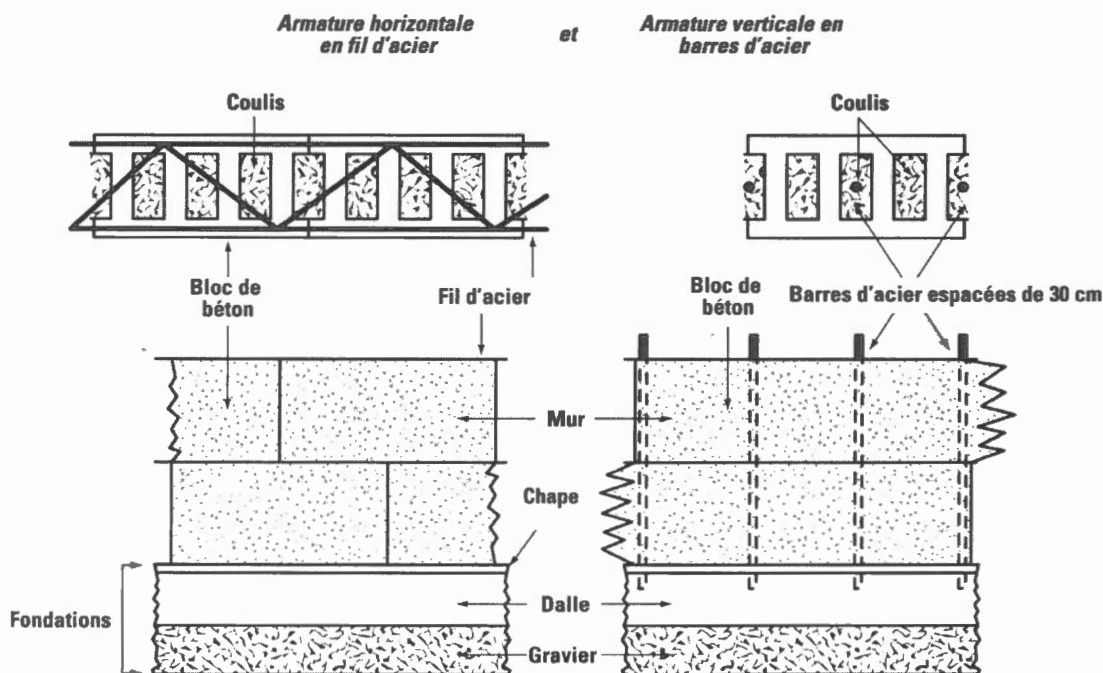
Modèle de fondations et de murs pour les dépôts de type 1.
